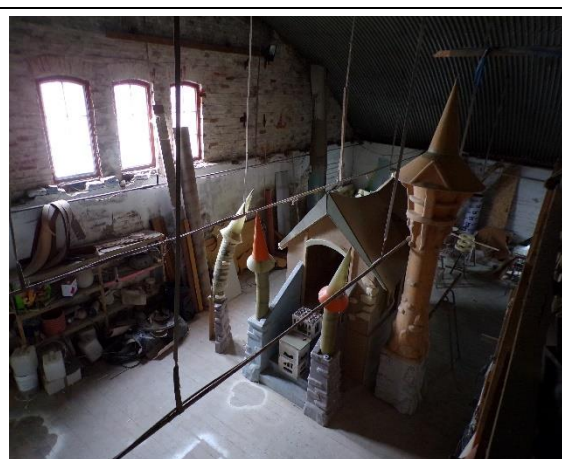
Obiekt E – Konstrukcja ścian nośnych
